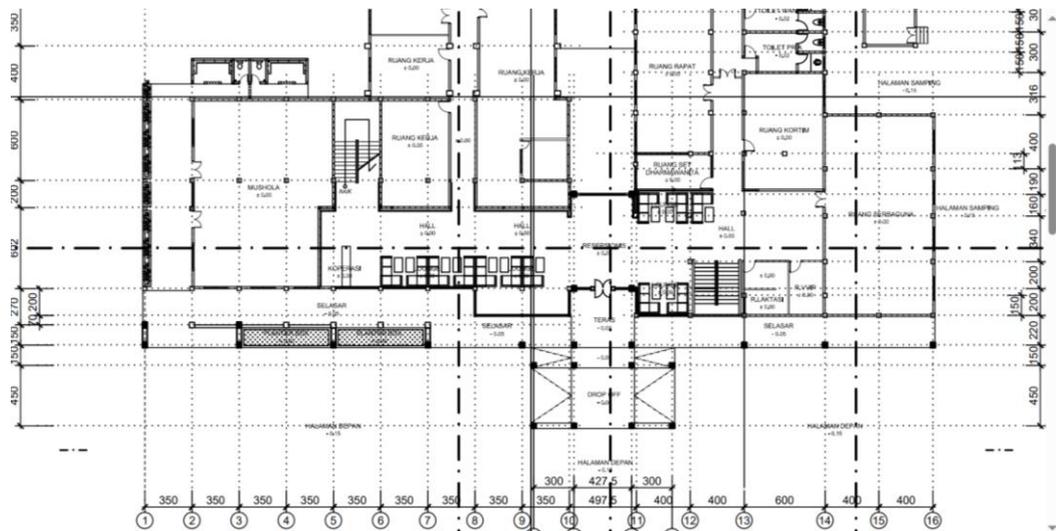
Penyatuan Bangunan Lama (Eksisting) dan Bangunan Baru dengan Metode Dilatasi Joint (Sumber : Foto Pribadi)
